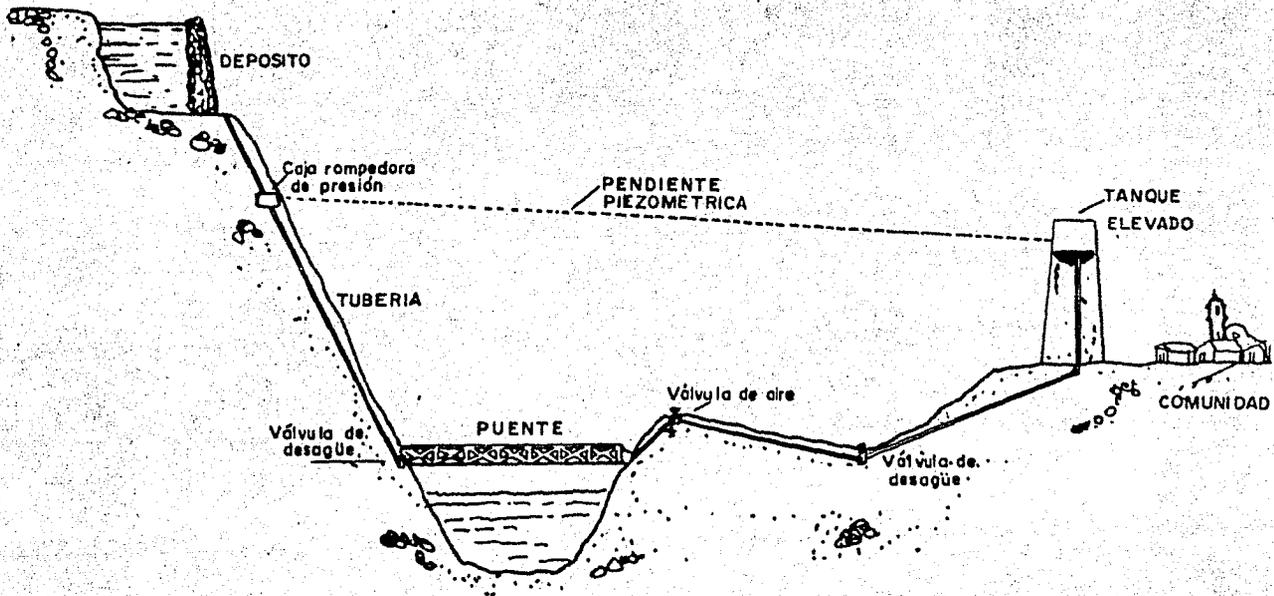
CONDUCCION. Perfil de terreno y localización de la tubería.
